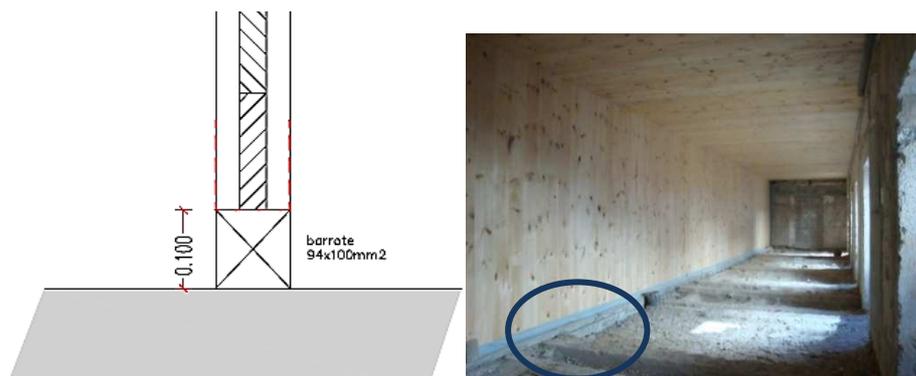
Pormenor construtivo – arranque da parede (Cortesia Tisem)
